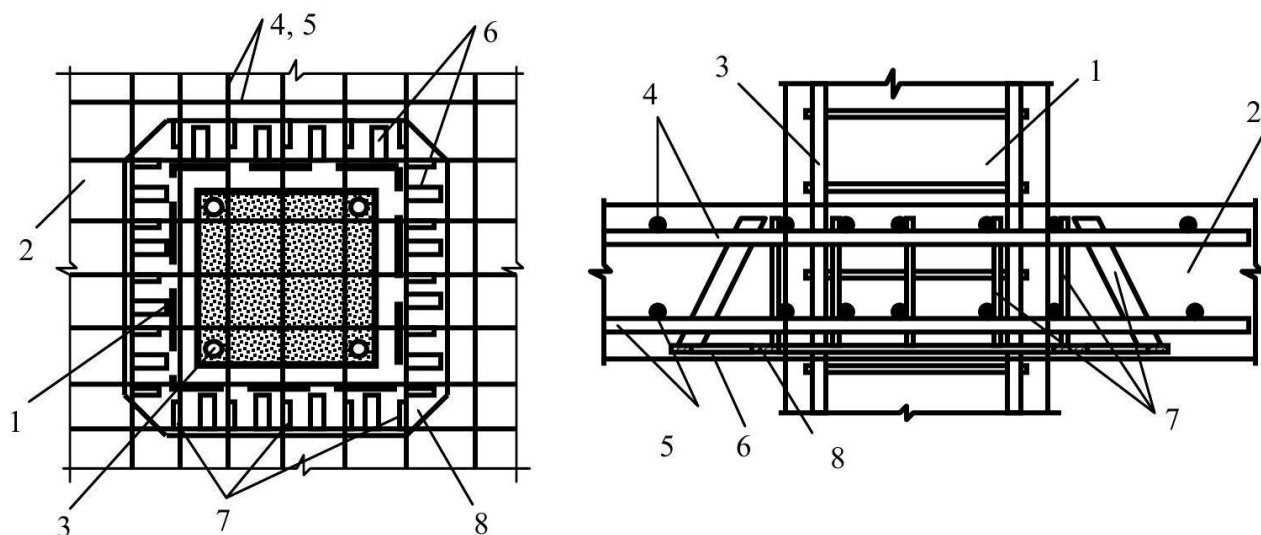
Схема вузла обпирання плити безбалковими перекриття на колону:
